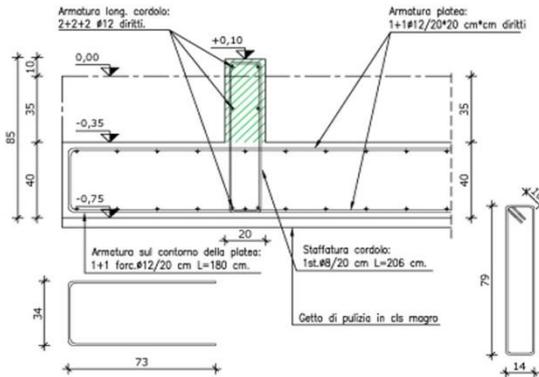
# PLATEA DI FONDAZIONE, ARMATURA E GETTO DEI CORDOLI
